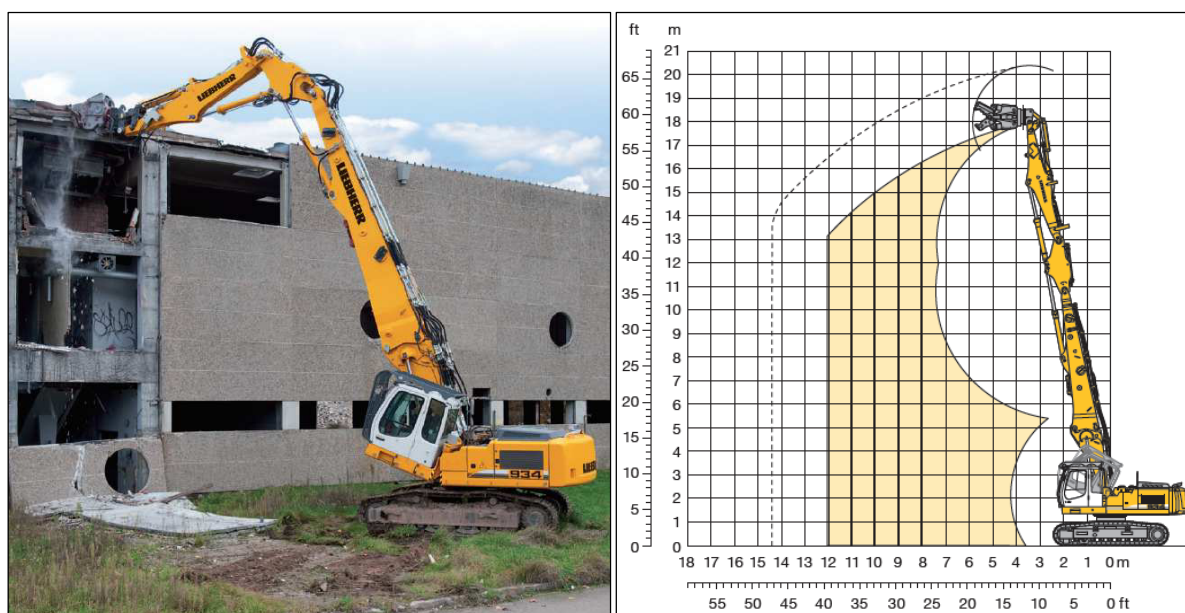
Demolizione di edificio perpendicolarmente alla disposizione delle travi
